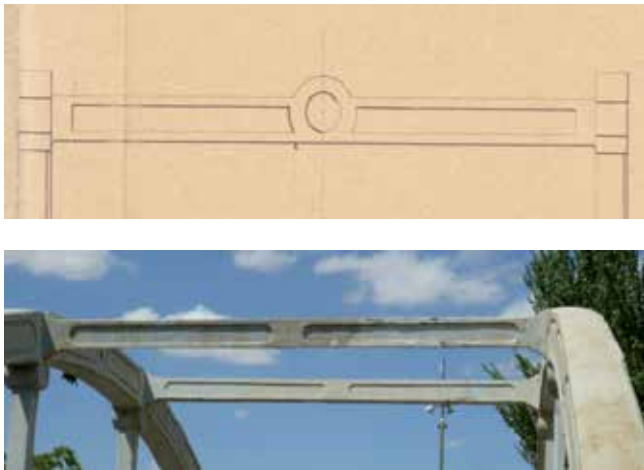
Vigas riostras, que evitan el vuelco de los arcos, ante el viento y las riadas (en proyecto y foto del autor)
